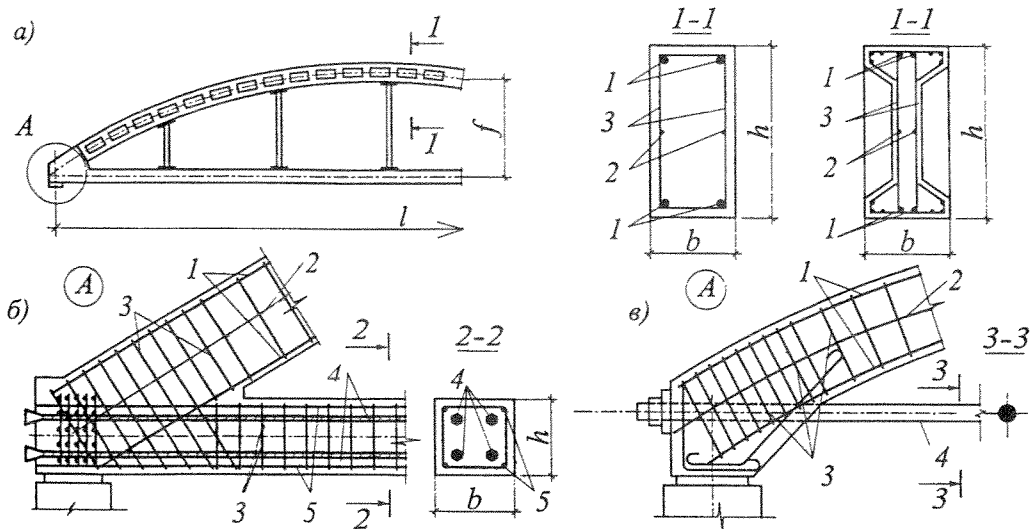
Сборная железобетонная арка с затяжкой:
